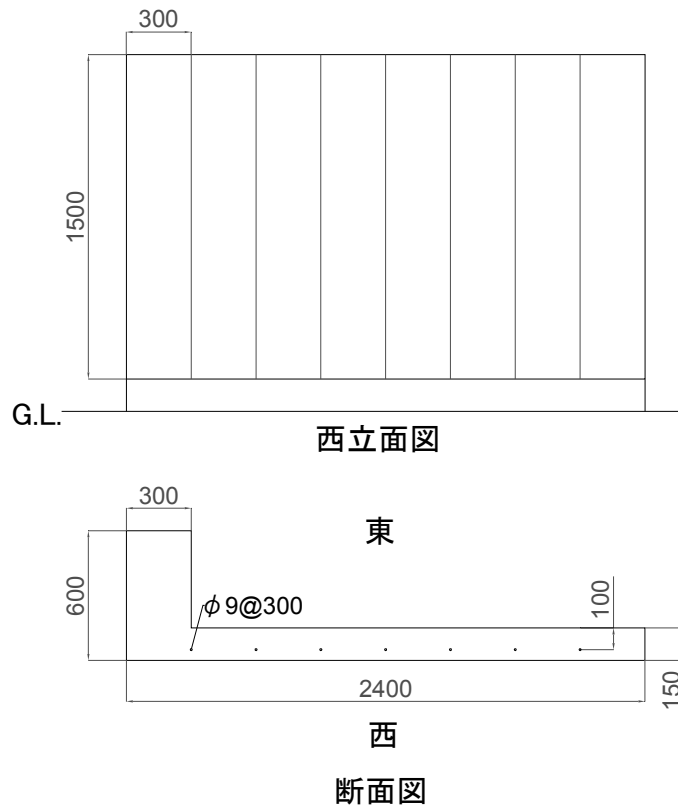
RC 塀の立面・断面図 (単位 : mm)
